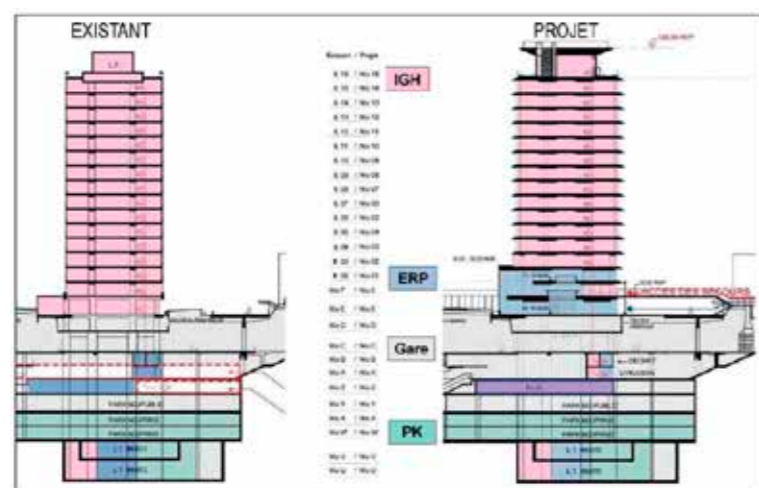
Coupes du bâtiment en situation actuelle et projet
